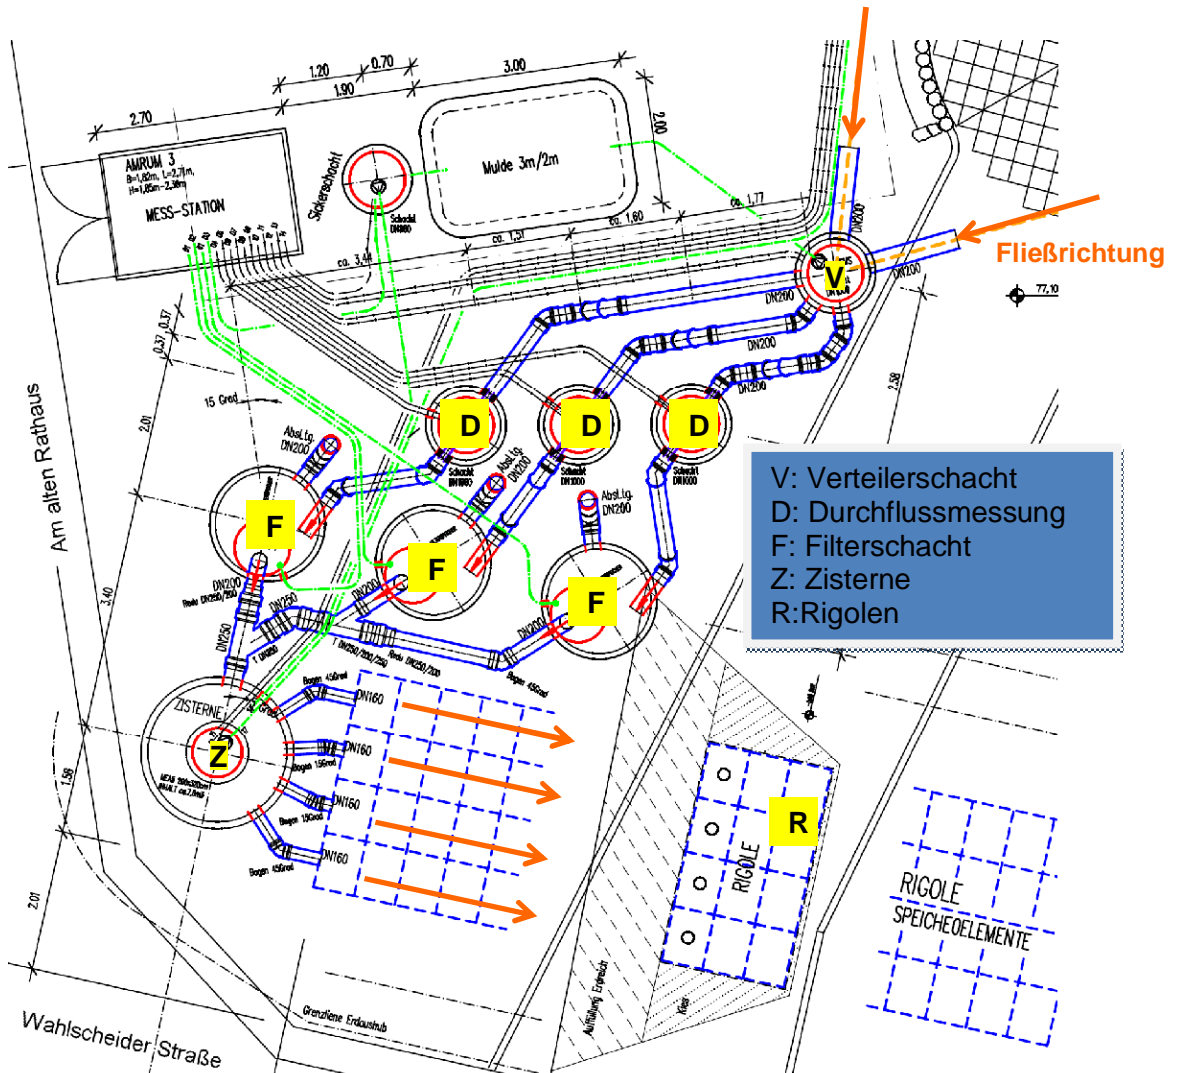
Übersichtsplan der gesamten Anlage, Fließschema (Grundriss)
